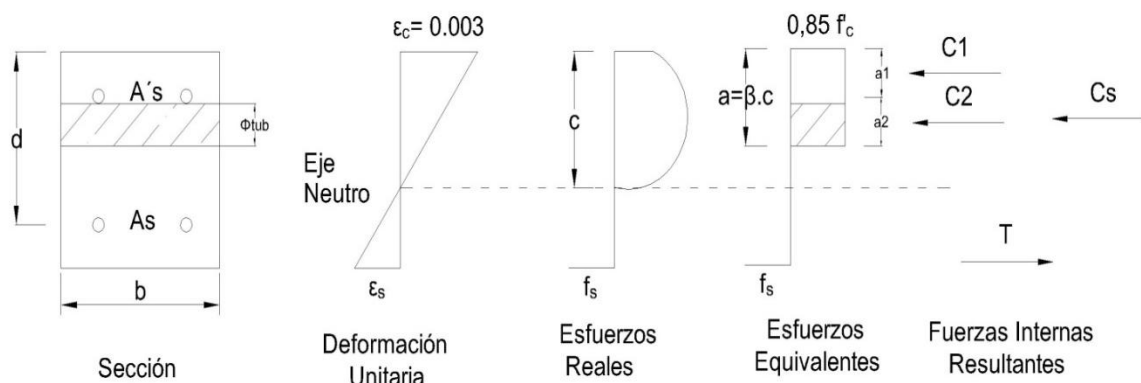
Sección de concreto doblemente Reforzada afectada por tubería en caso 2.
